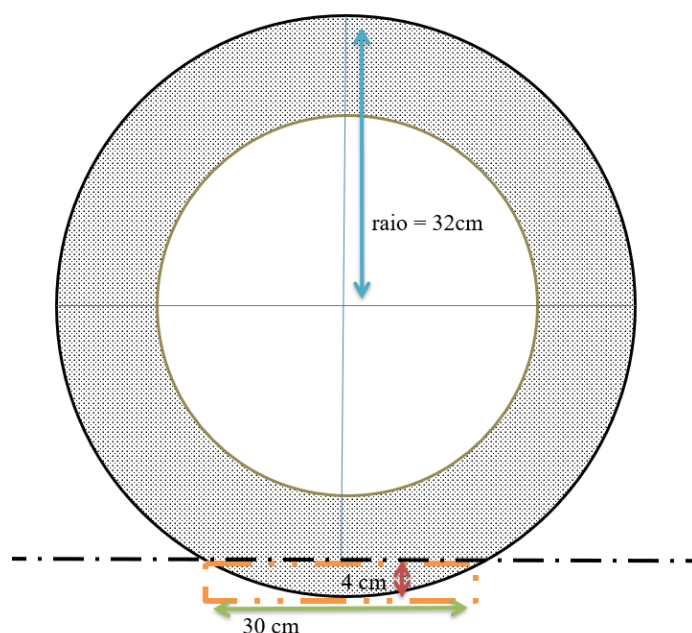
Exemplo de possível condicionamento à circulação gerado por fenda no pavimento da via com 30 cm de abertura.
